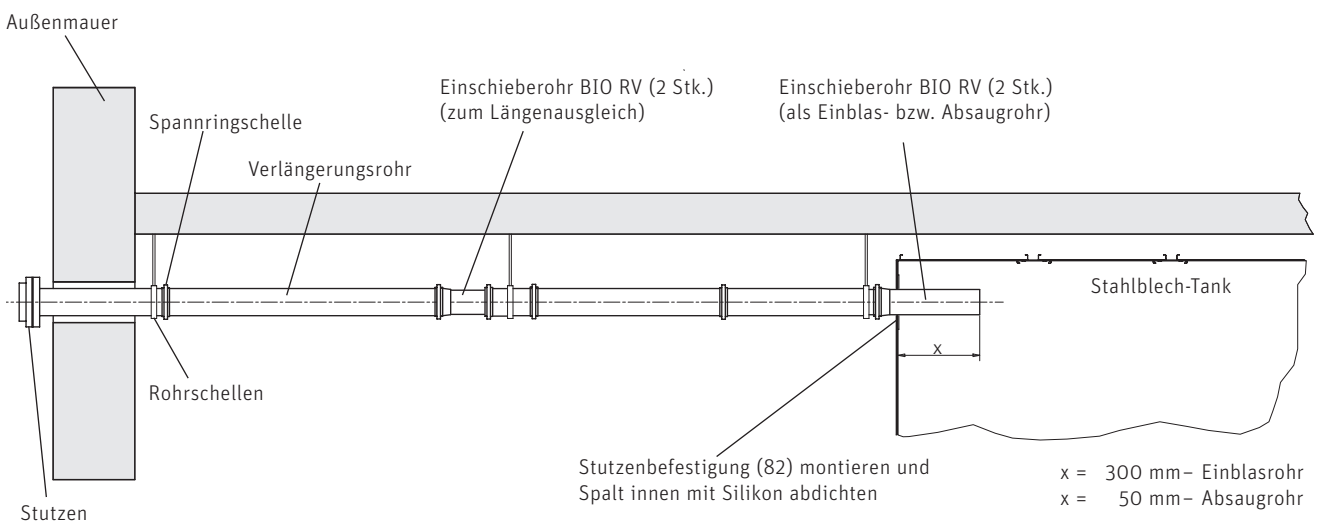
Stutzen mit Verlängerungsrohre und Stahlblech-Tank – Seitenansicht
